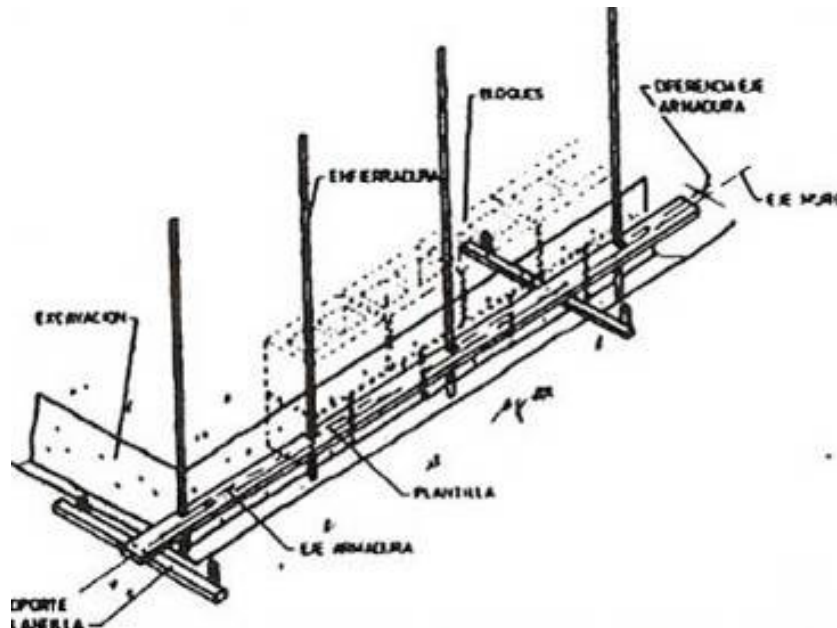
Detalle de la plantilla para fijar posiciones de las armaduras verticales (tensores) en el cimiento y sobrecimiento.
